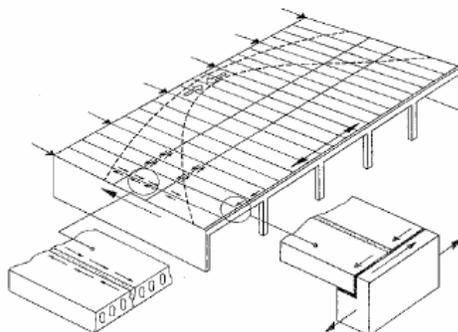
Efeito de Arco em pavimentos pré-fabricados com lajes alveolares. Fonte: NEVES & PEIXOTO (2004).
